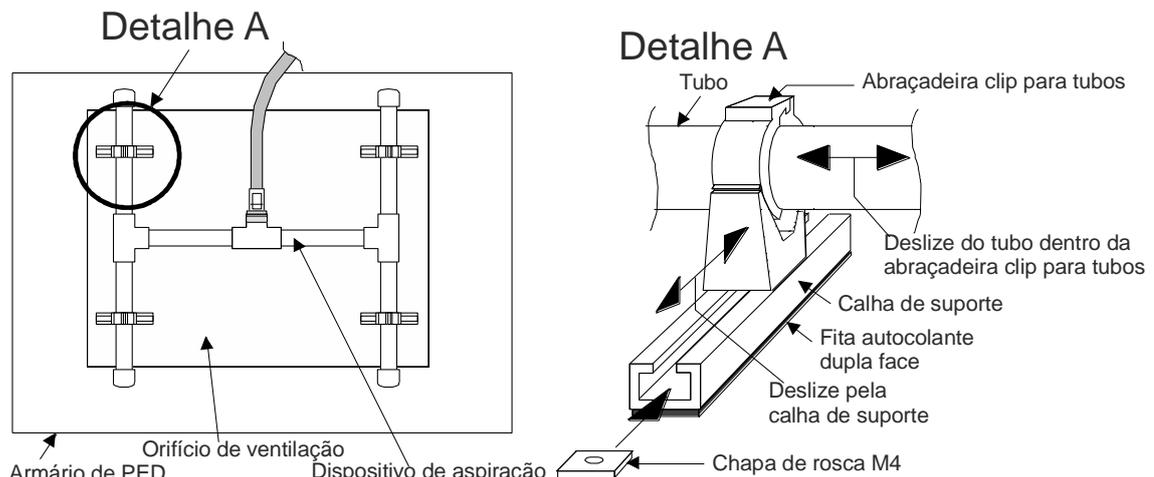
fixação de um dispositivo de aspiração sem aparafusar
